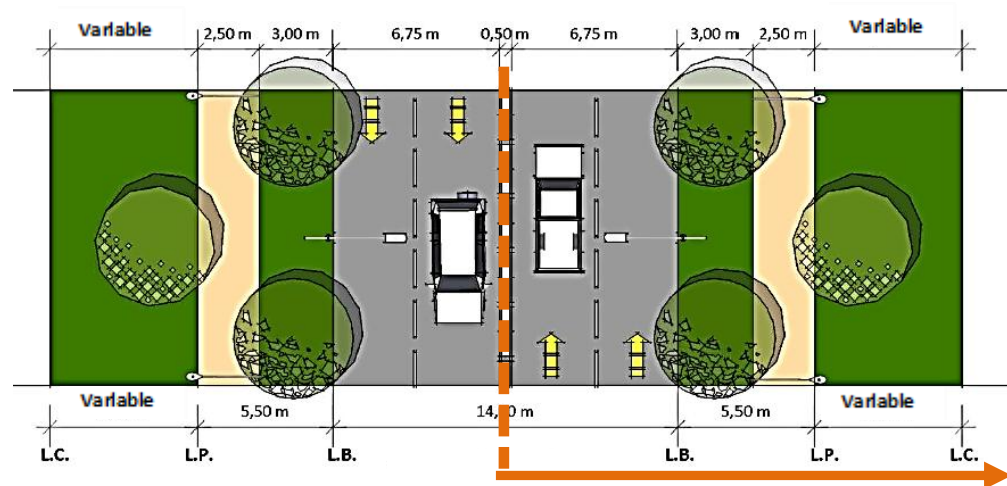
Planta del Perfil Servidumbre y Perimetral. Fuente: Equipo Asesor PP.
